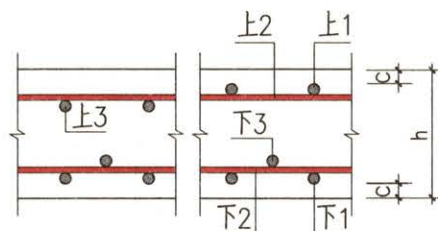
板厚范围内上、下部各层钢筋定位排序示意
